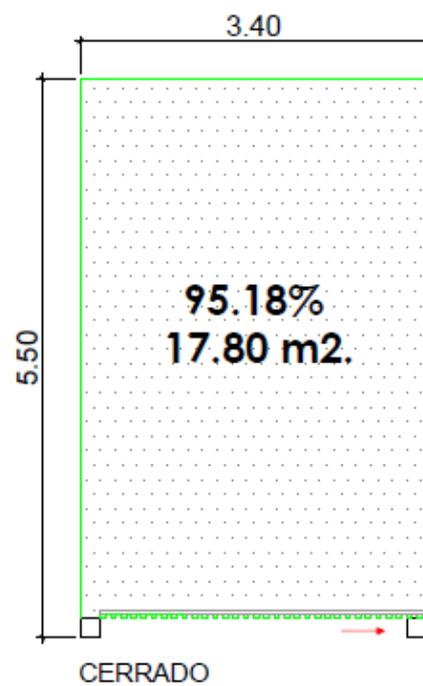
Vista en planta de la superficie del garaje con puerta cerrada.
